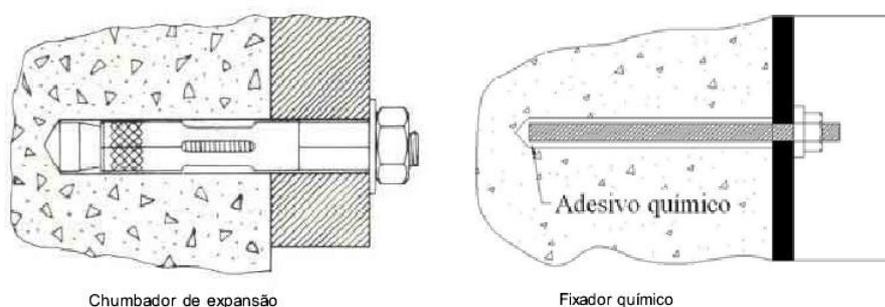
Soluções de fixadores para construção pré-existente em concreto armado
